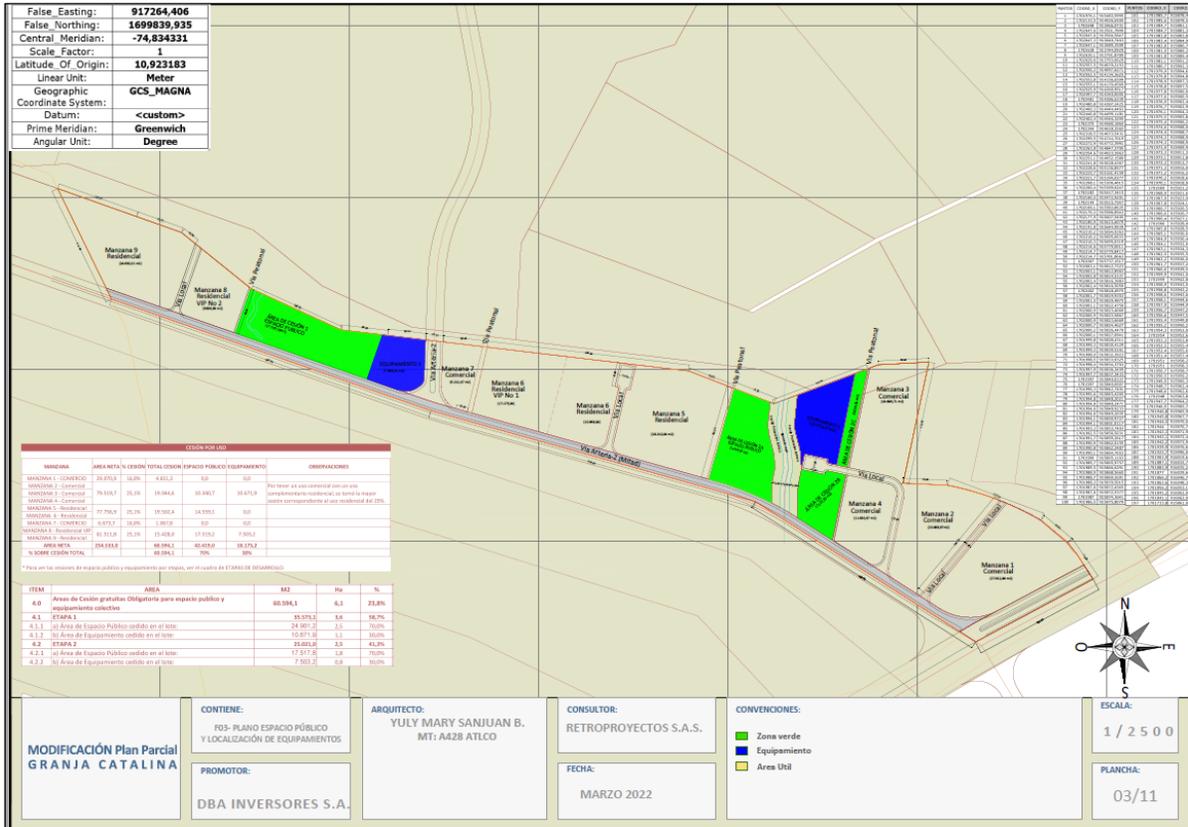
F03 Plano espacio Público y equipamiento Modificado.
